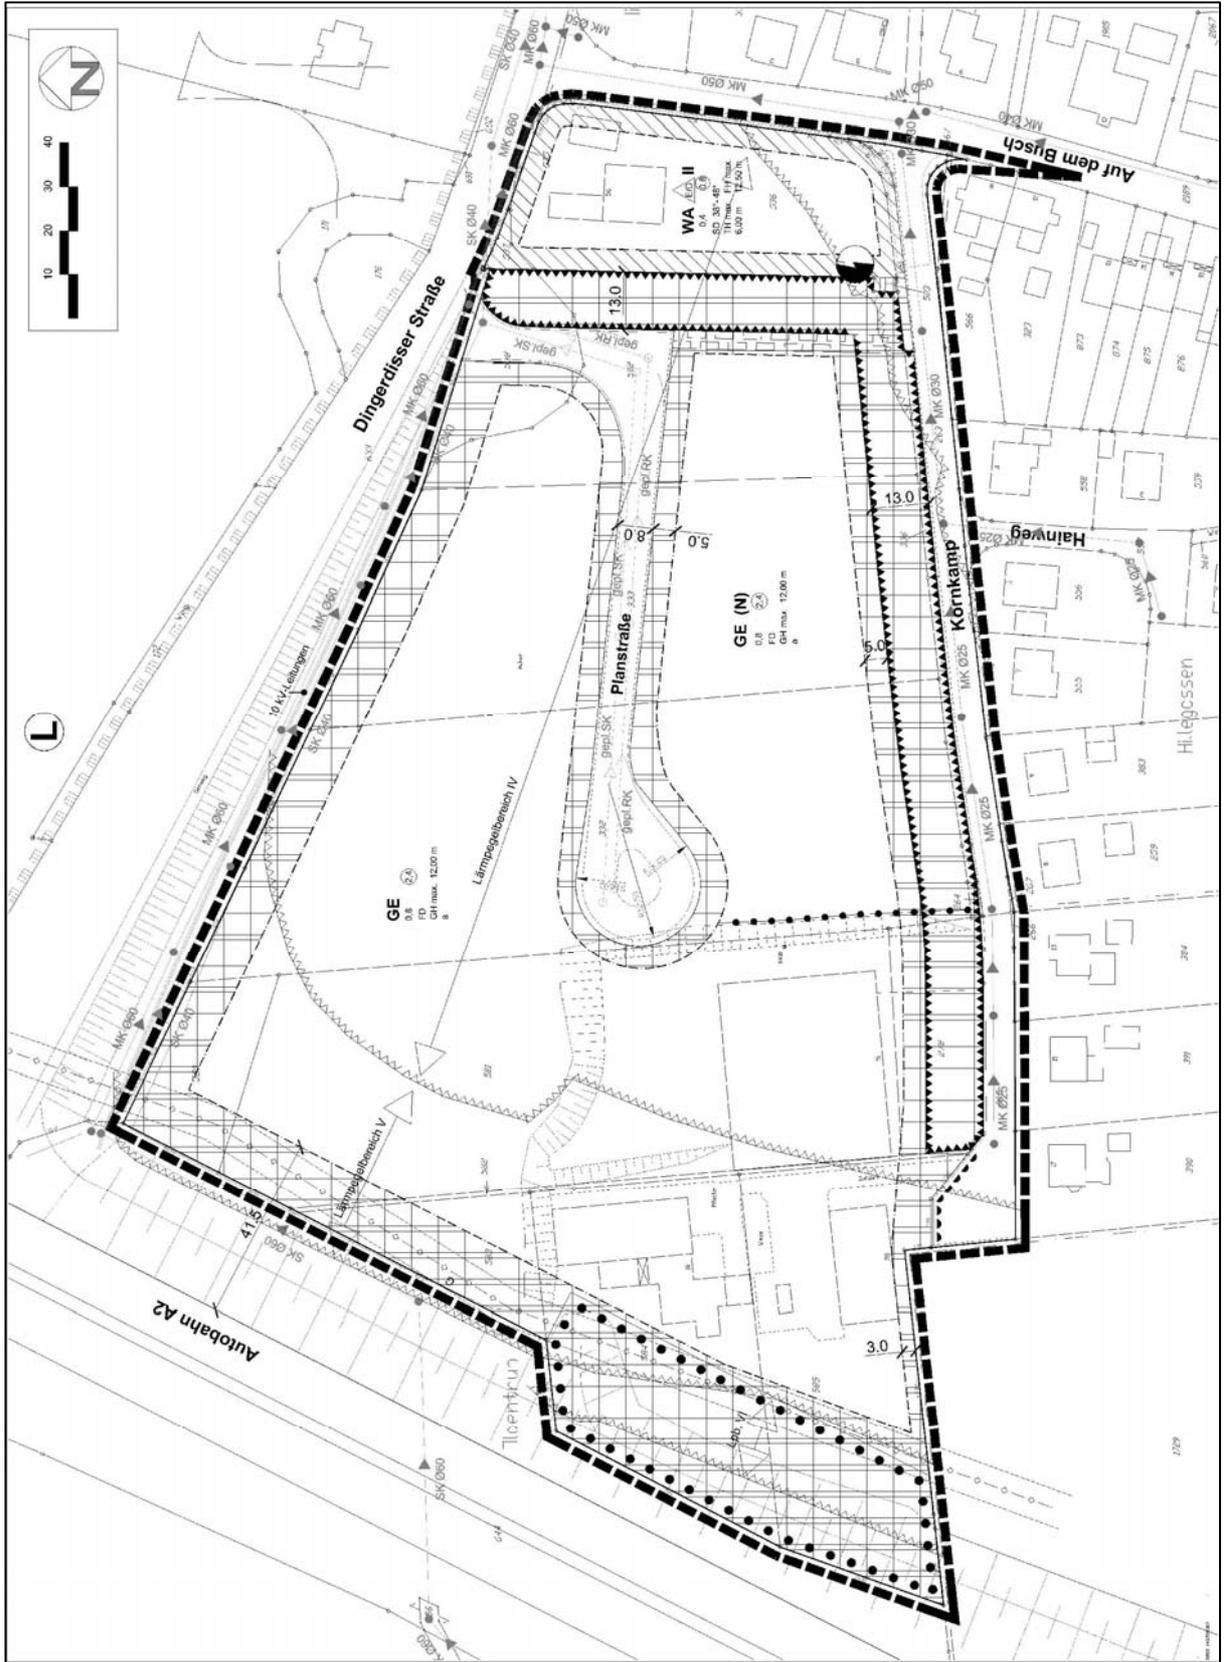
Bebauungsplan Nr. III/O 11, Nutzungsplan-Entwurfssfassung
